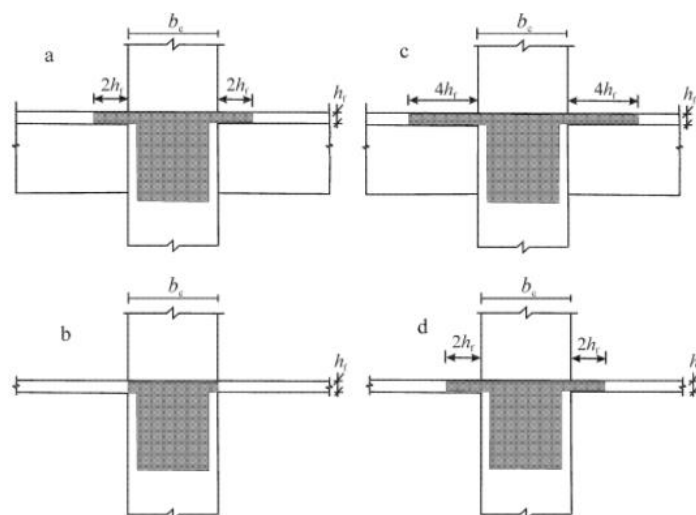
Largura efetiva do banzo, b_{eff} , para vigas ligadas a pilares [EC8].
